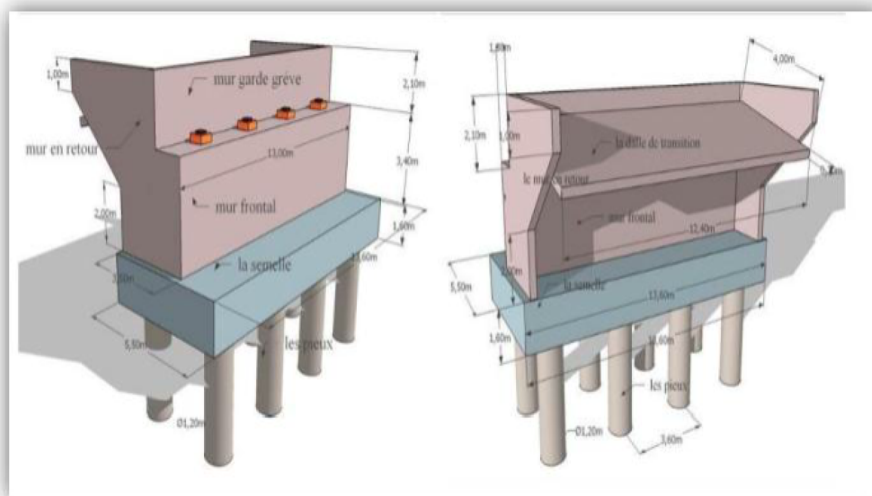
vue en 3D des différentes composantes d'une culée remblayée
